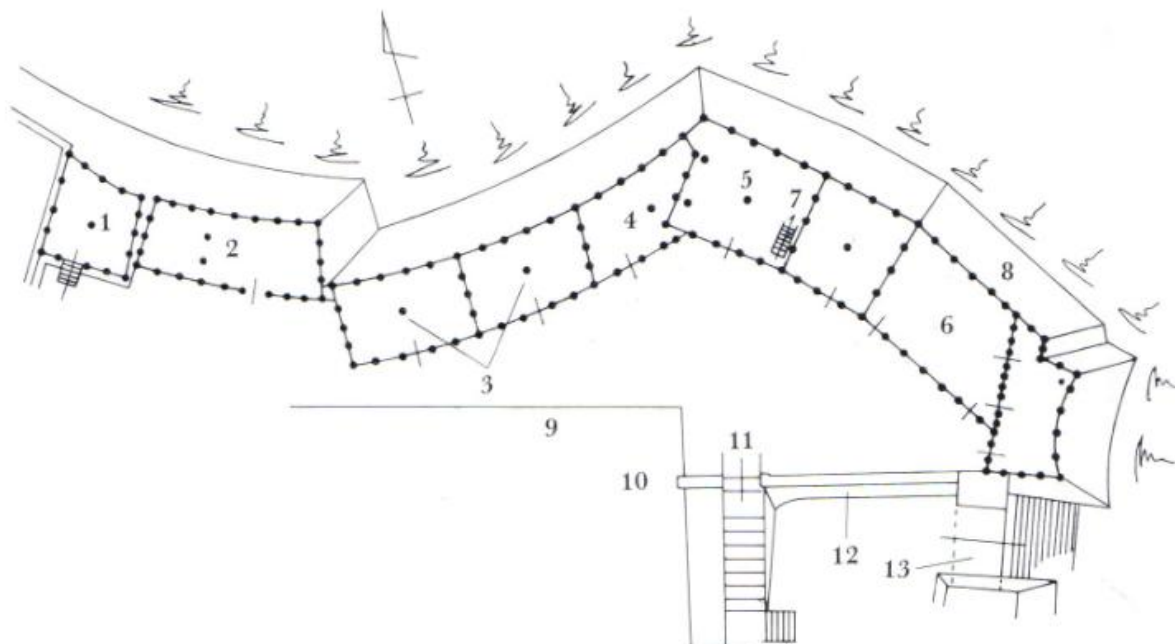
Planta de uma *watari-yagura* do castelo de Himeji.
